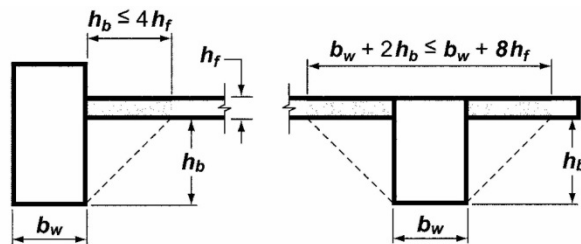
Definición de vigas tipo “L” y “T” (American Concrete Institute, 1999)
